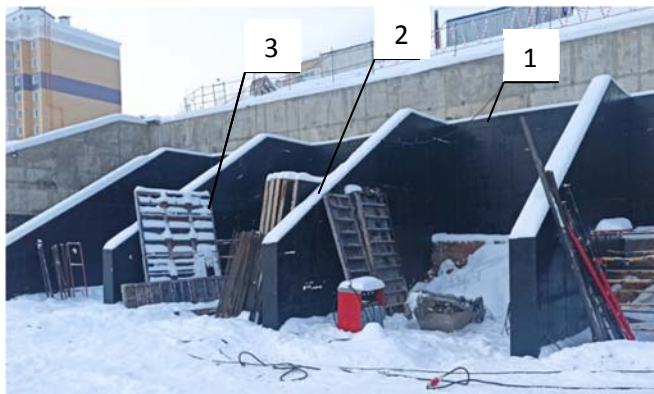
Монолитная железобетонная уголкового подпорная стена с контрфорсами как удерживающая заглубленная строительная конструкция деформированной подпорной стены: 1 – существующая монолитная железобетонная уголкового подпорная стена; 2 – монолитная железобетонная уголкового подпорная стена с контрфорсами 3
